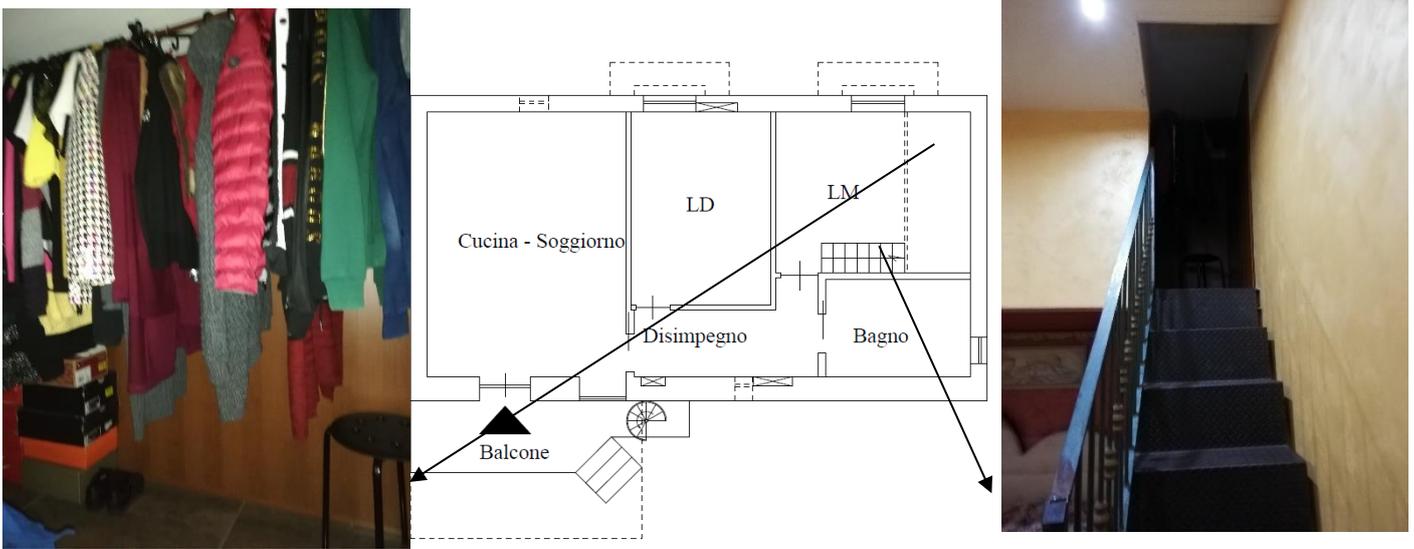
Individuazione fotografica degli interni del bene oggetto di pignoramento.
